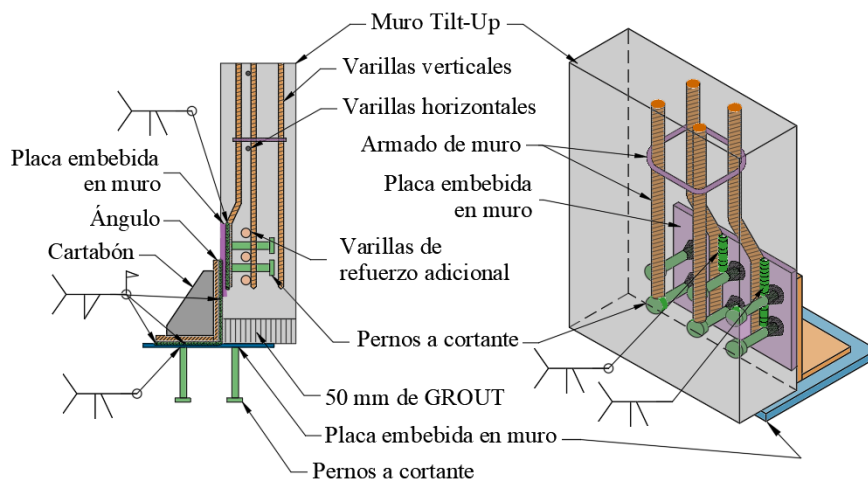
b - Conexión de los muros con las zapatas corridas
